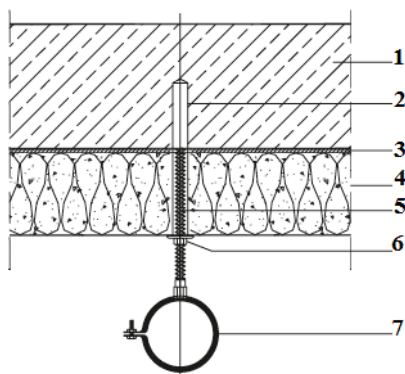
Крепежное соединение сквозь минеральную изоляционную плиту Multipor: 1 — железобетонное перекрытие; 2 — легкий раствор Multipor; 3 — забивной анкер или компактный дюбель; 4 — резьбовой стержень; 5 — гайка с подкладной шайбой Ø 30 мм; 6 — хомут для трубы; 7 — изоляция перекрытия Multipor DI
